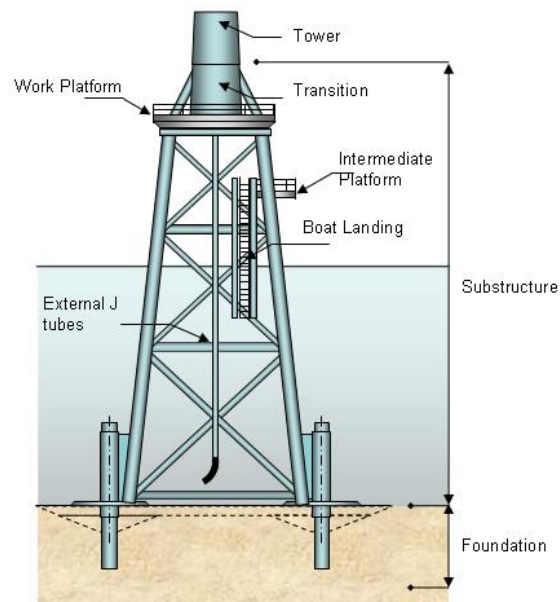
Cimentación por subestructura tipo jacket (Fuente: [19])
